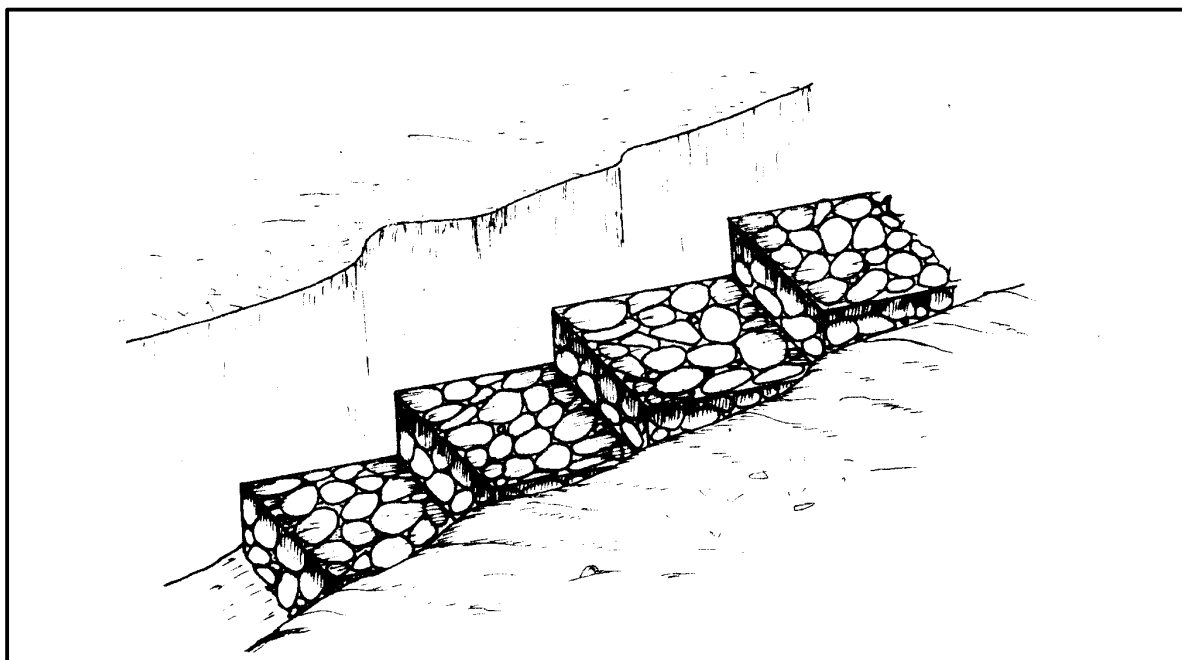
Protección del lecho de la quebrada con muros escalonados (andenes), utilizando bloques de roca o concreto armado.
